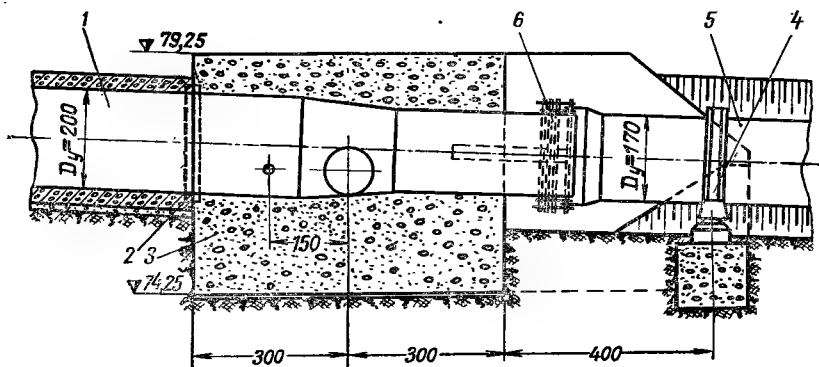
Соединение железобетонного монолитного трубопровода со стальным:
